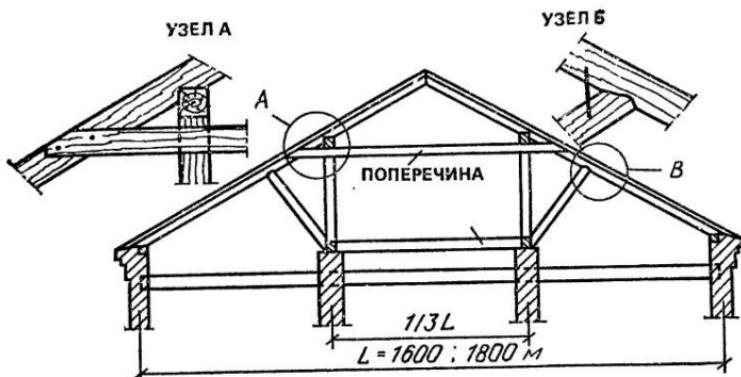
Двускатная крыша с двумя стойками и подкосами, опретыми на две капитальные стены
